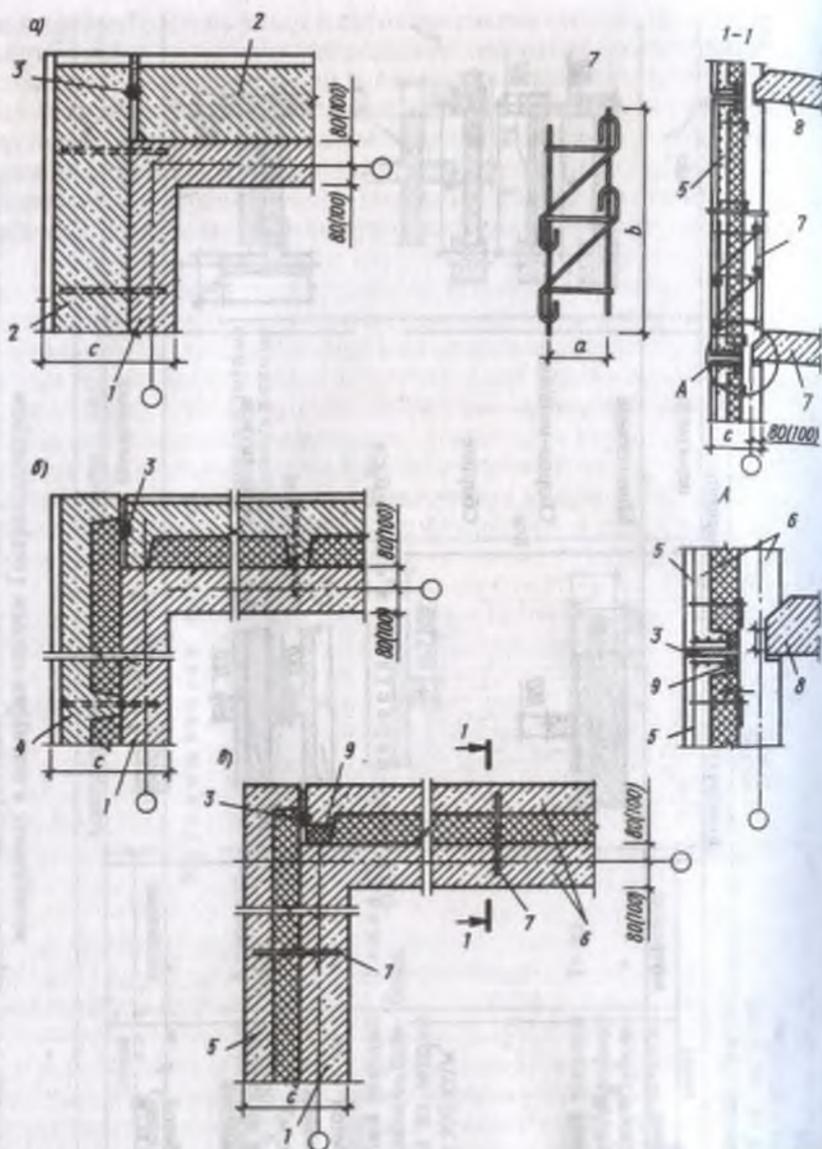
Монолитные наружные стены с утепляющими и отделочными наружными навесными панелями-скорлупами:
